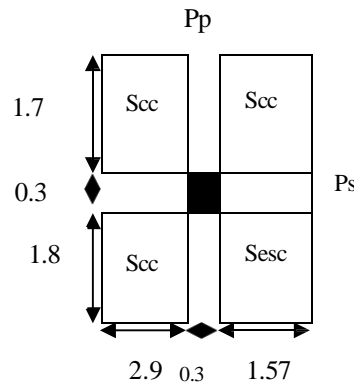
Surface afférente du poteau terrasse inaccessible et étages courant
